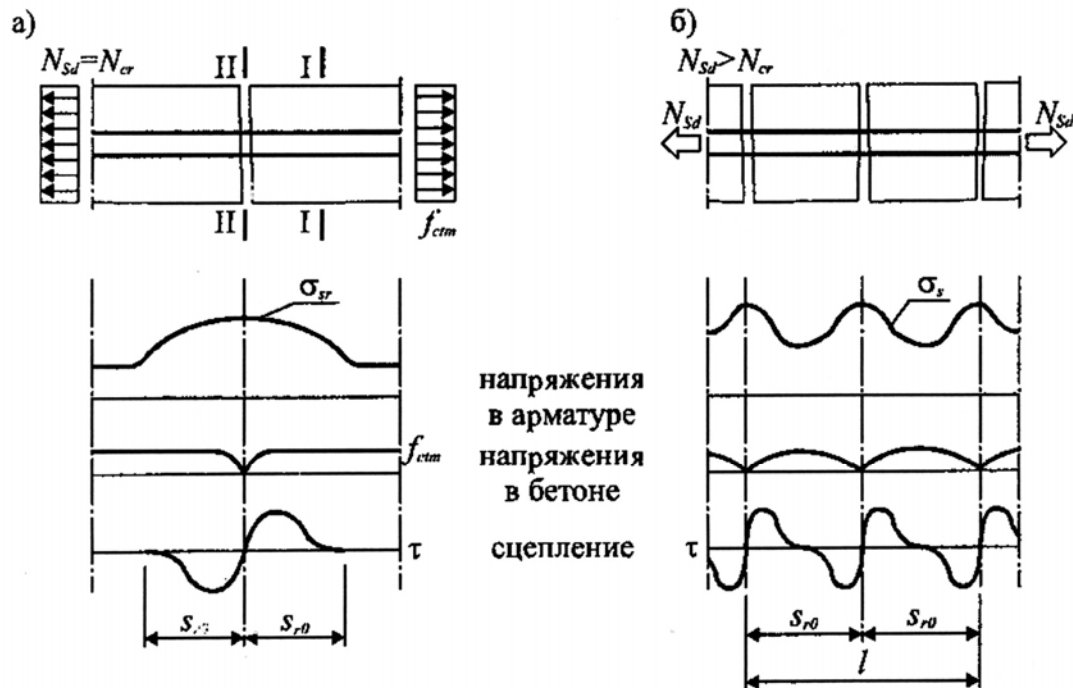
Распределение напряжений в арматуре и бетоне центрально растянутого элемента:
